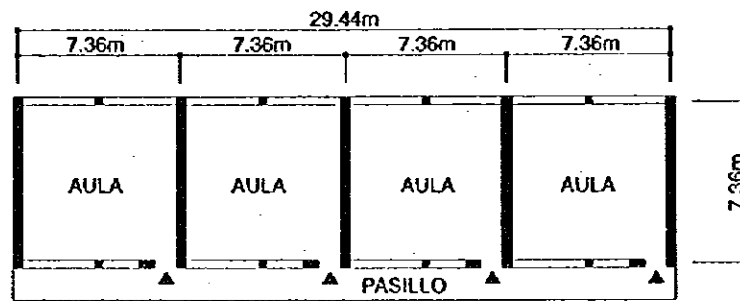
Plan superficial de edificio de tipo cuatro aulas con pared divisoria móvil
